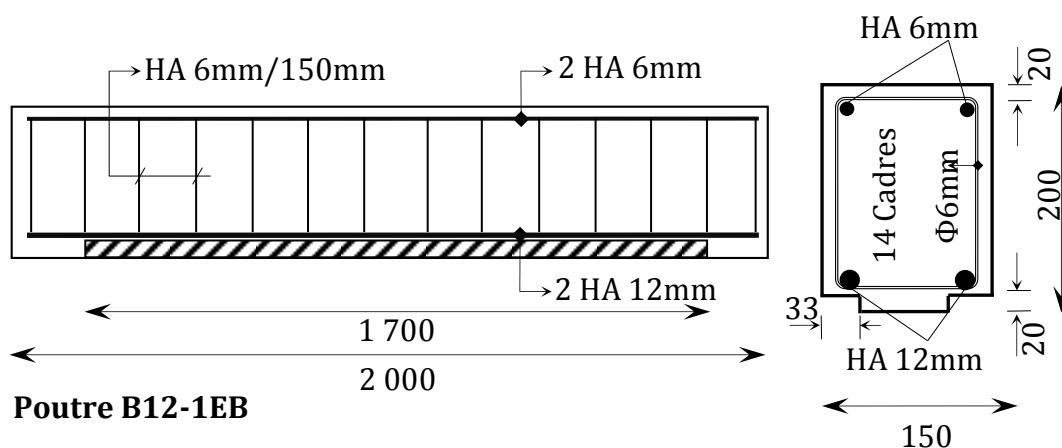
Caractéristiques géométriques et ferrailage des poutres B12. (Toutes les dimensions en mm).
